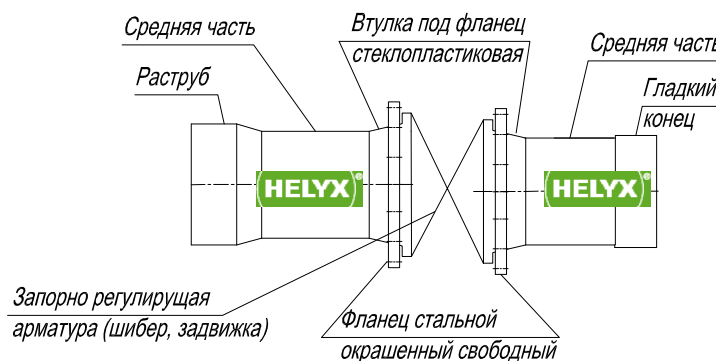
Фланцевое соединение патрубков под фланец с запорно-регулирующей арматурой на стальных свободных фланцах на концах.
